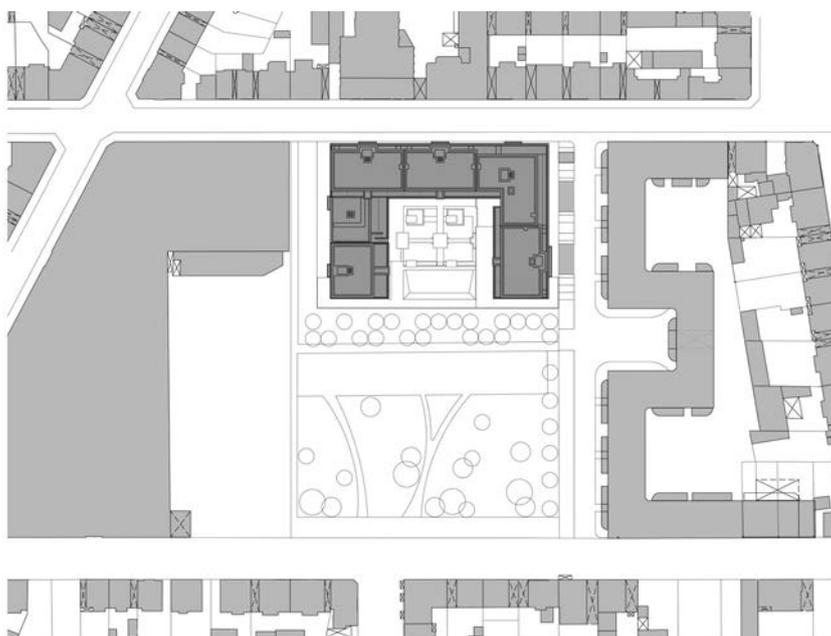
Lageplan zum Projekt, Quelle: Karl Dudler Architekten
